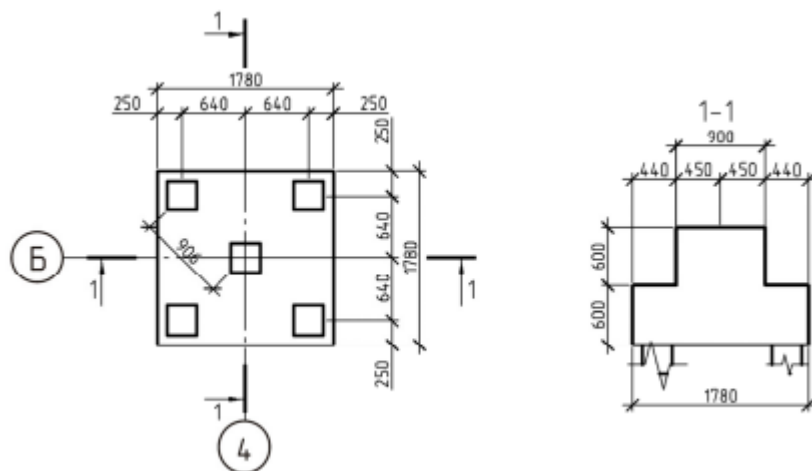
Схема расположения свай и поперечный разрез ростверка
